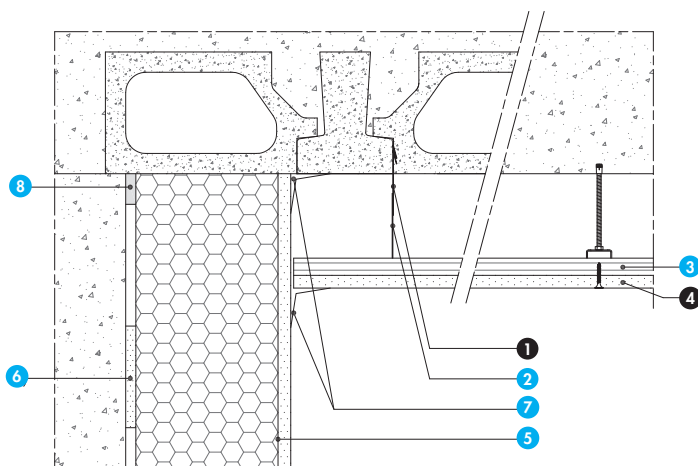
Étanchéité à l'air de la jonction plafonds/support/doublage
